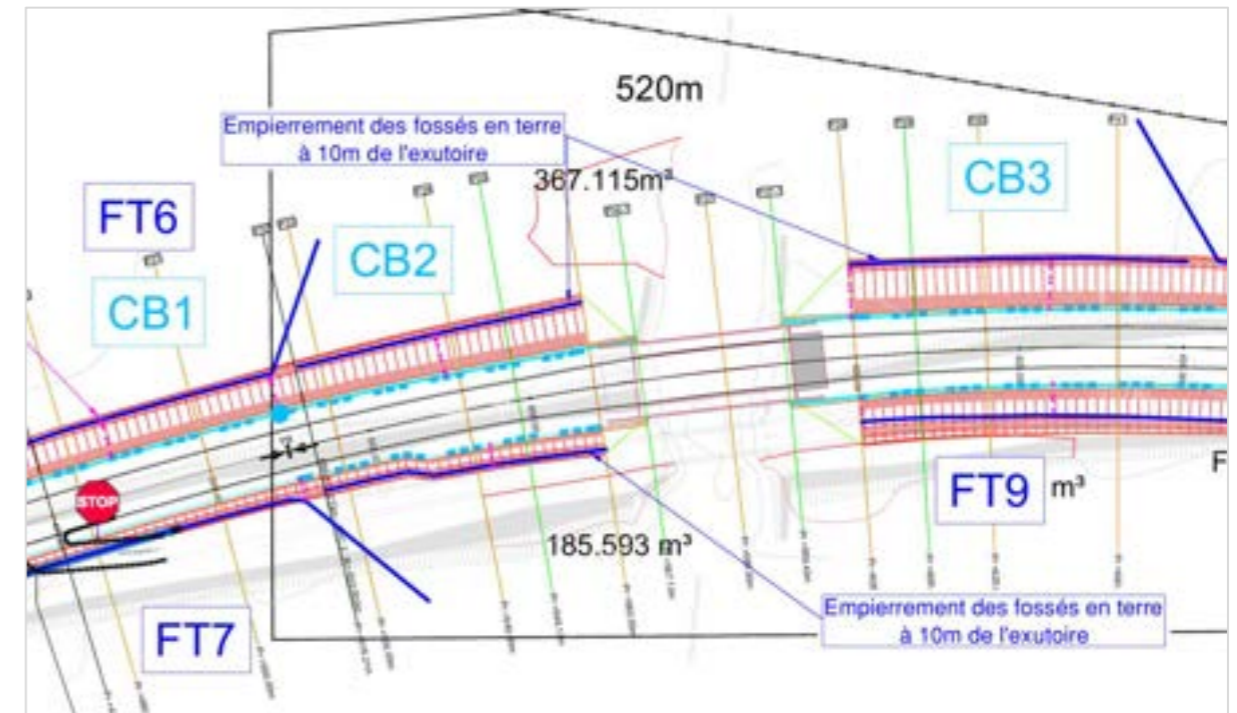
Extrait du plan d'assainissement - Fossés empierrements
